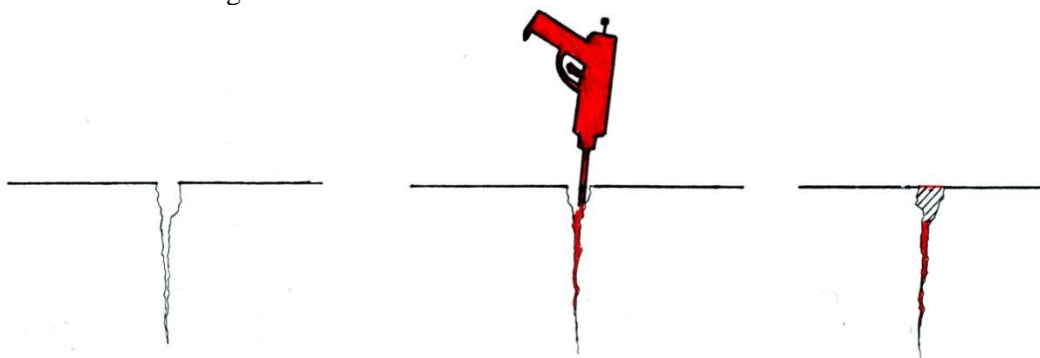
a 36 Esquema de reparación de fisura con bocana ancha.
